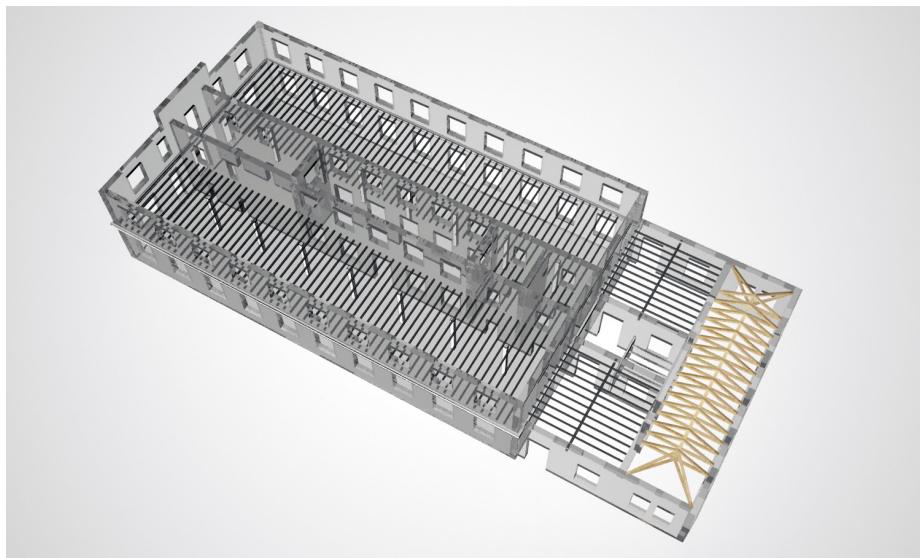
, Estructura Intervención 1970 Planta Baja. Nuevos pilares en planta baja, correa perimetral de atado y nuevo forjado en patio.
